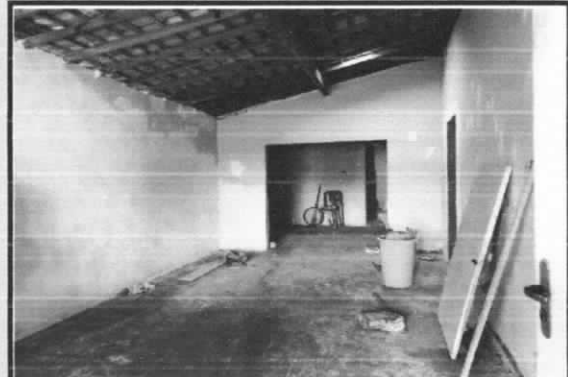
SALÃO INTERNO 01 - TÉRREO
